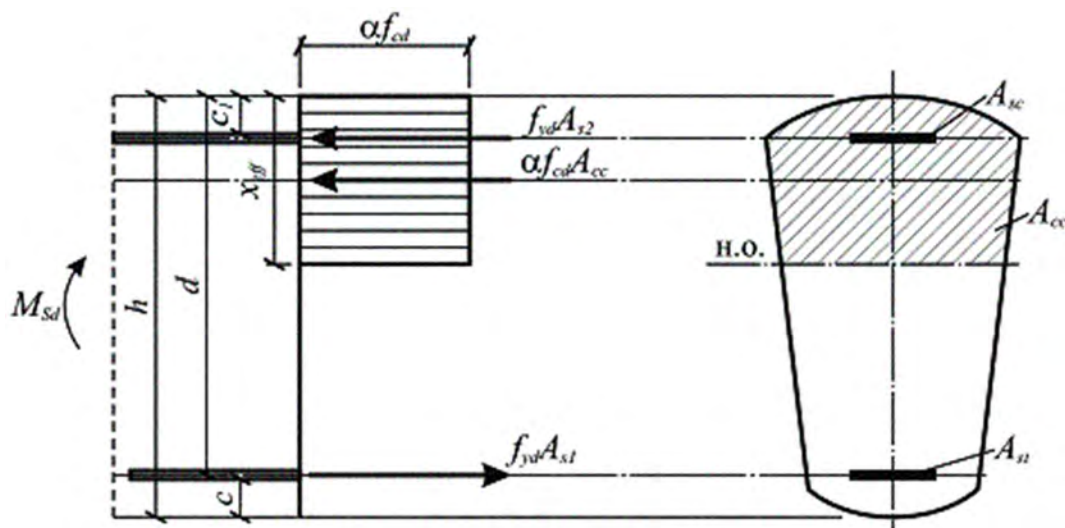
Схема усилий и эпюра напряжений в сечении, нормальном к продольной оси изгибаемого железобетонного элемента
